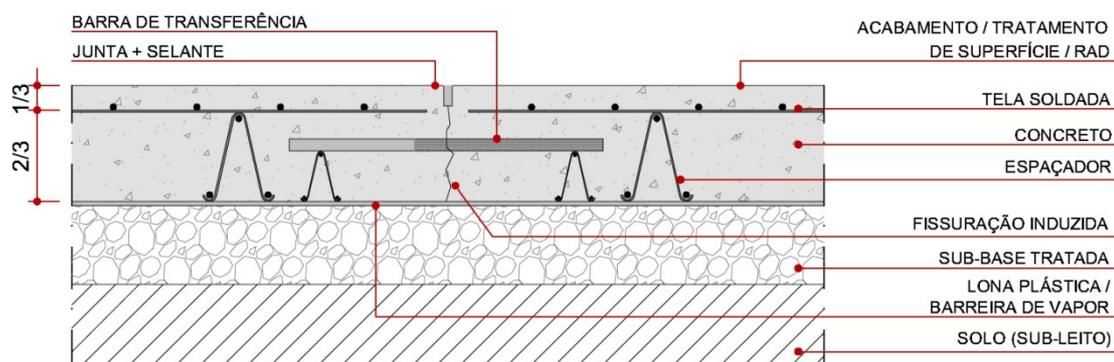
Junta Serrada e fissuração induzida
